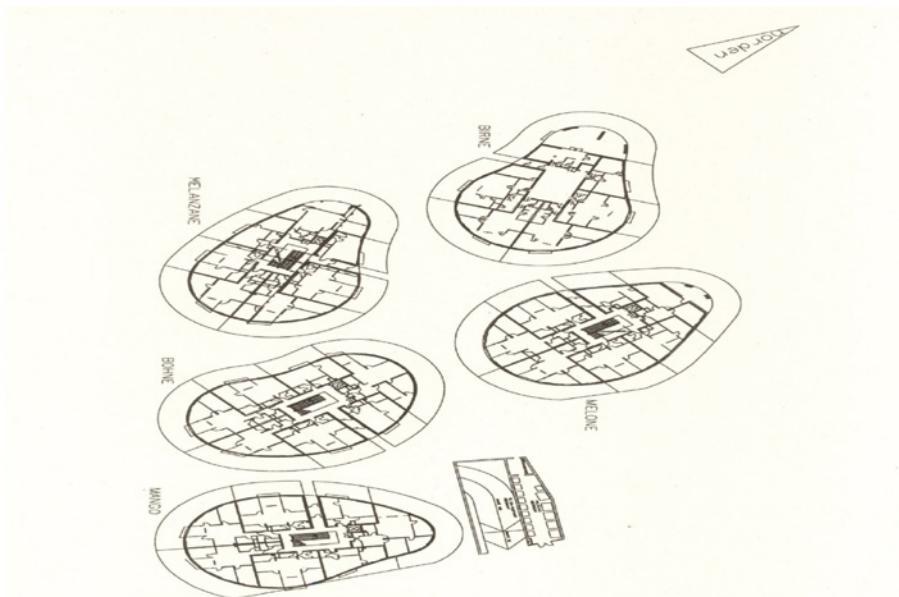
Grundrisse »Dreherstraße« [Architekt Lautner]
